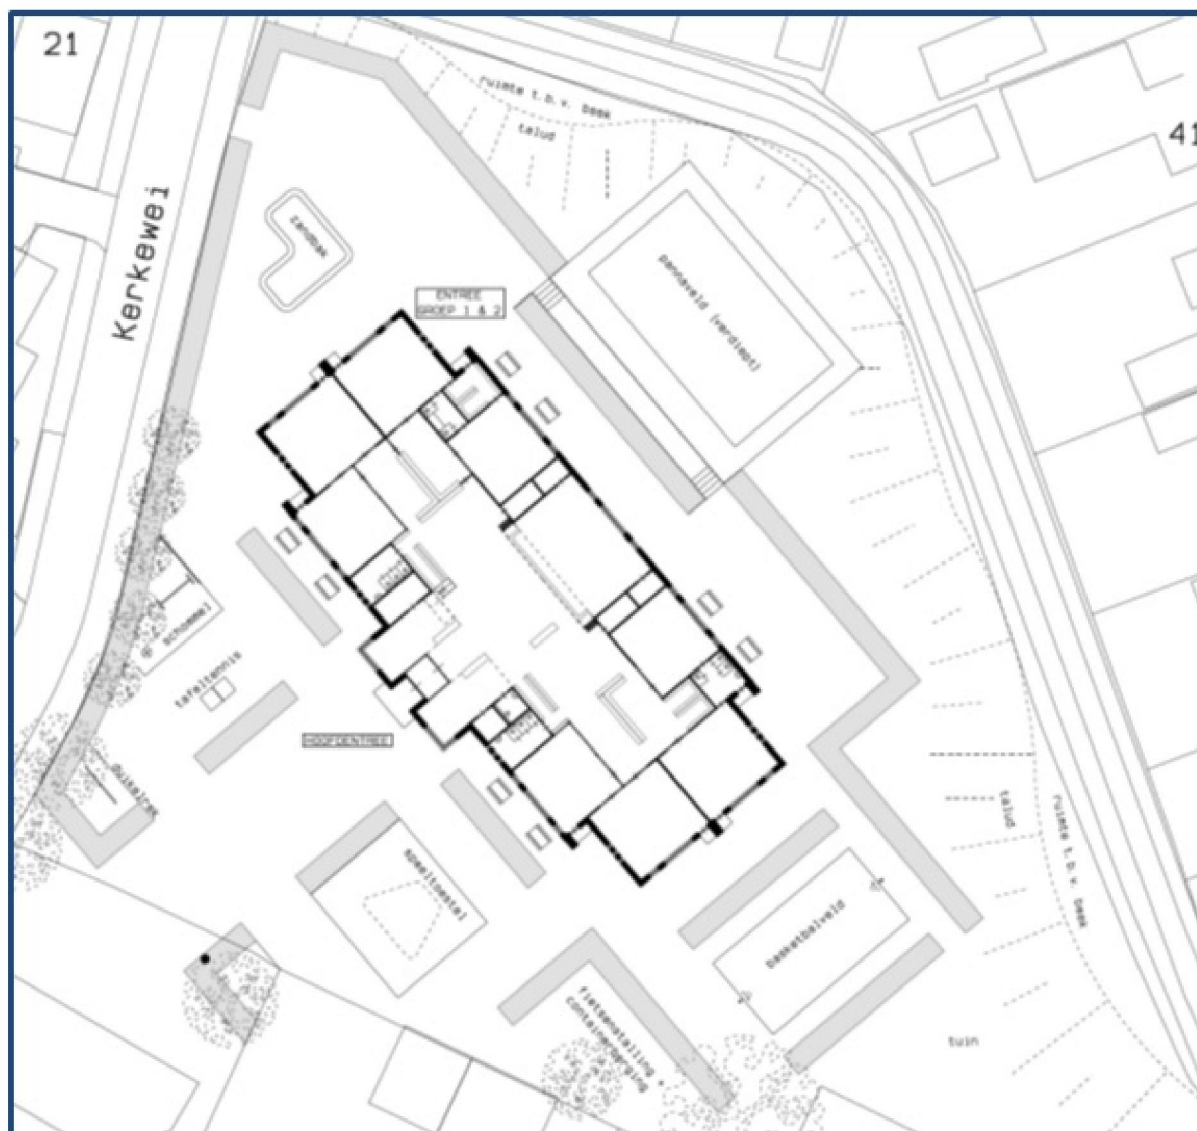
Plattegrond nieuwe basisschool De Kerkewei (Bron: Peters & Lammerink Architecten)
